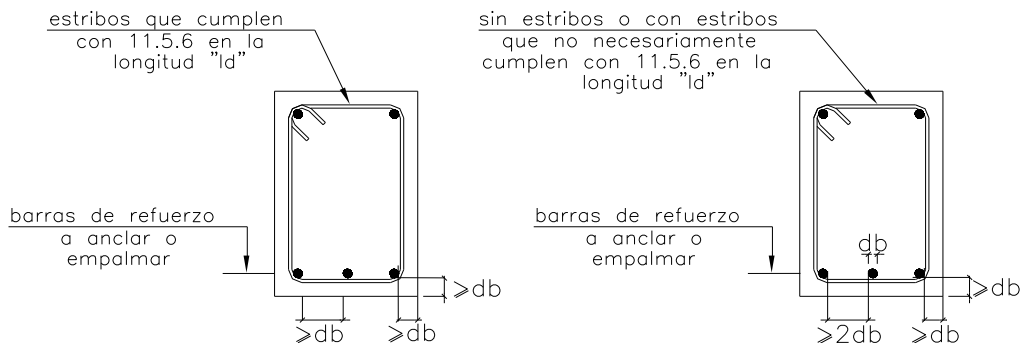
Condiciones para la longitud de desarrollo (Tabla 12.1) de barras en tracción
